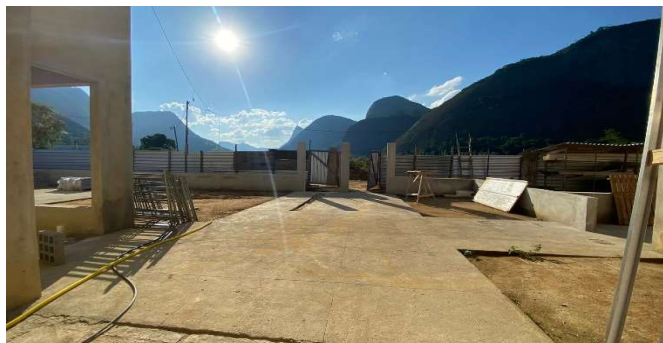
EMBOÇO OU MASSA ÚNICA EM ARGAMASSA TRAÇO 1:2:8, PREPARO MECÂNICO COM BETONEIRA 400 L, APLICADA MANUALMENTE EM PANOS CEGOS DE FACHADA (SEM PRESENÇA DE VÃOS).
